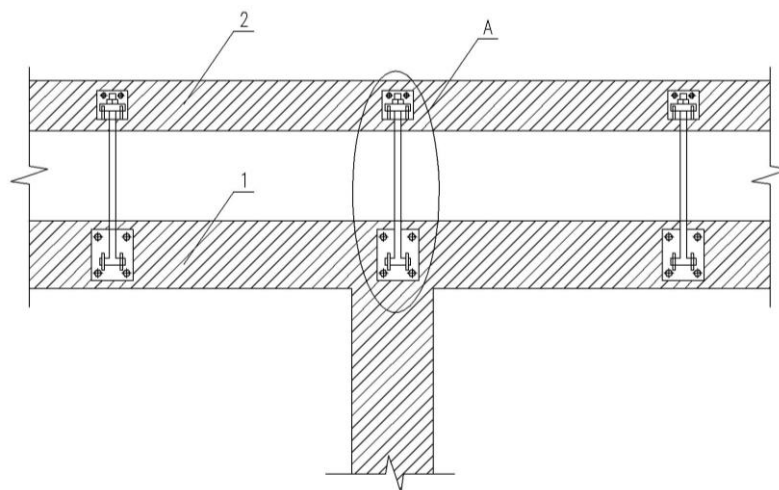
Расположение замков для строительных конструкций на стенах транспортного коридора хранилища отработавшего ядерного топлива (план) 1 – стена, раскрепленная поперечными стенами; 2 – раскрепляемая стена; А – замок для строительных конструкций, установленный с регулярным шагом вдоль раскрепляемой стены
